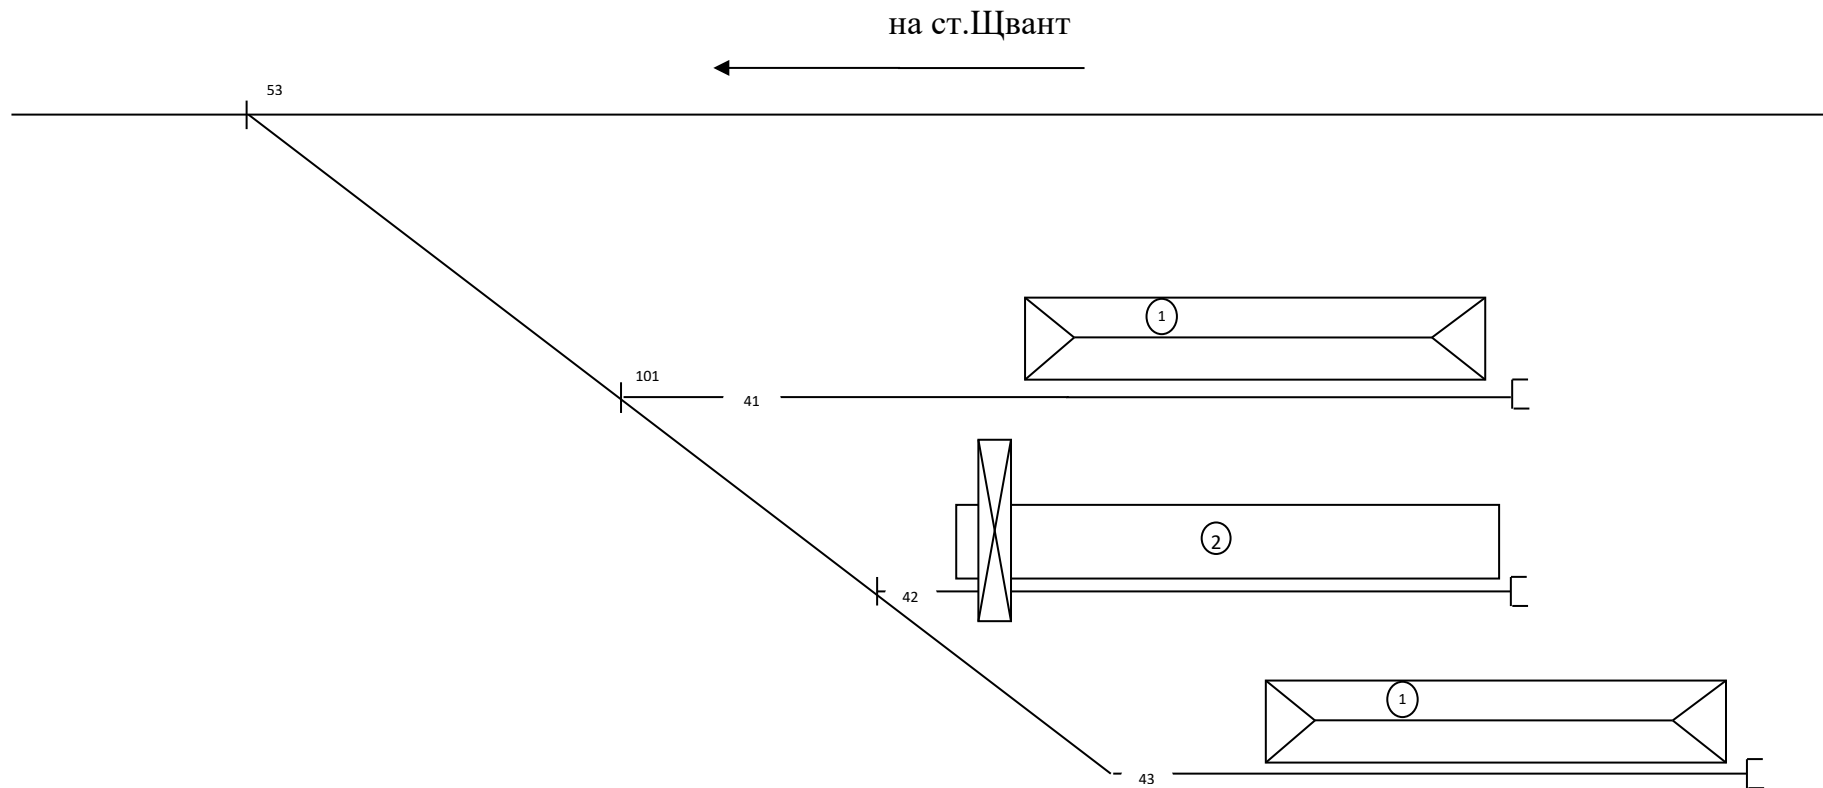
Немасштабна схема п/к №3 ст.Щвант
